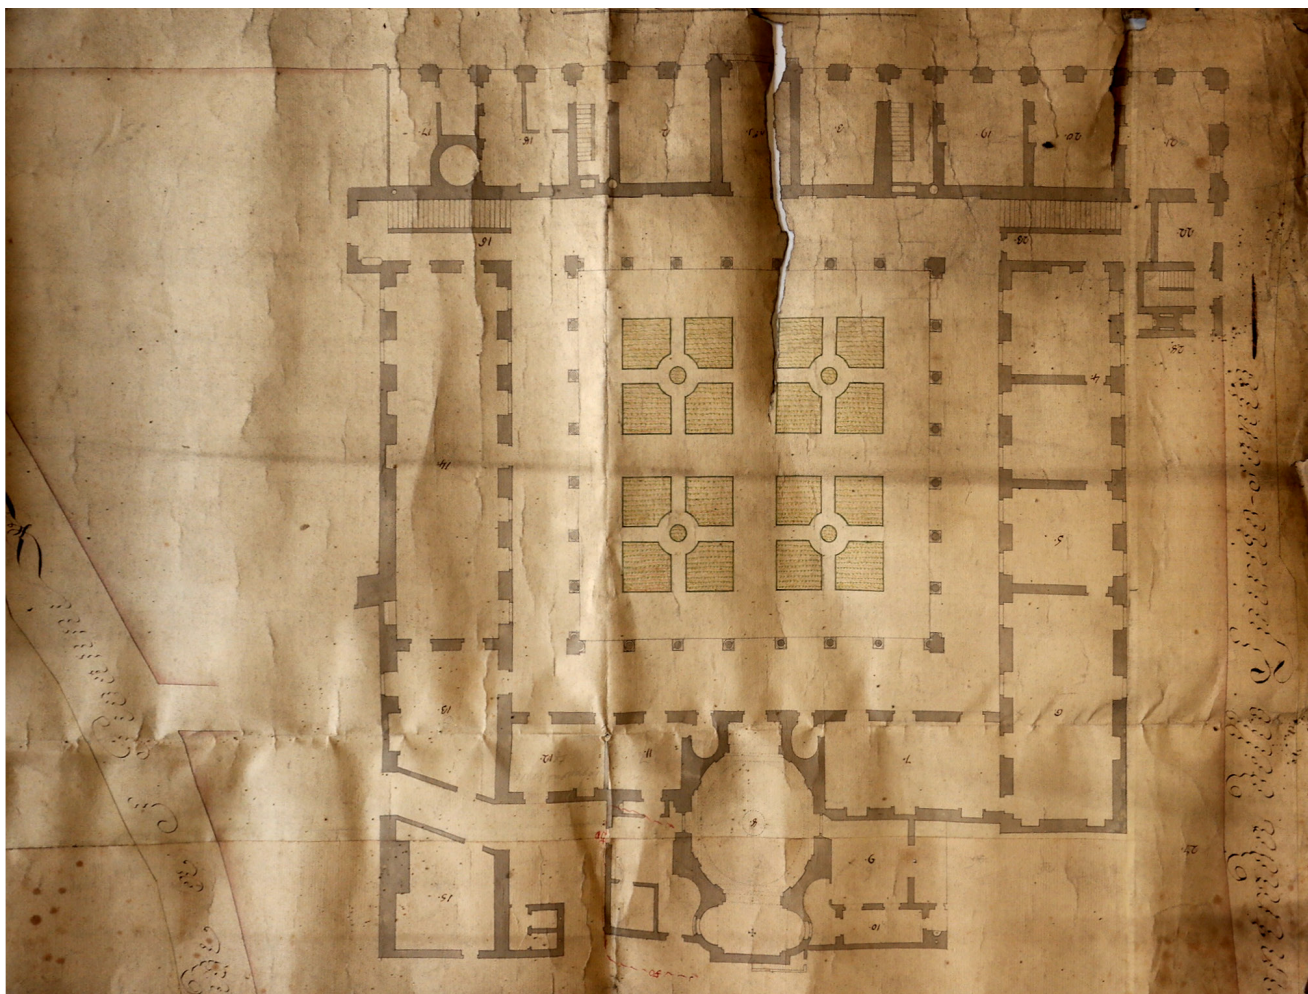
Planimetria del piano terreno del complesso del Seminario, prima degli interventi di stravolgimento commissionati a Carlo Ceroni (ASMT, *Carte e Disegni*, 8, «Maison du Seminaire de Turin n.1 Seminario»).
